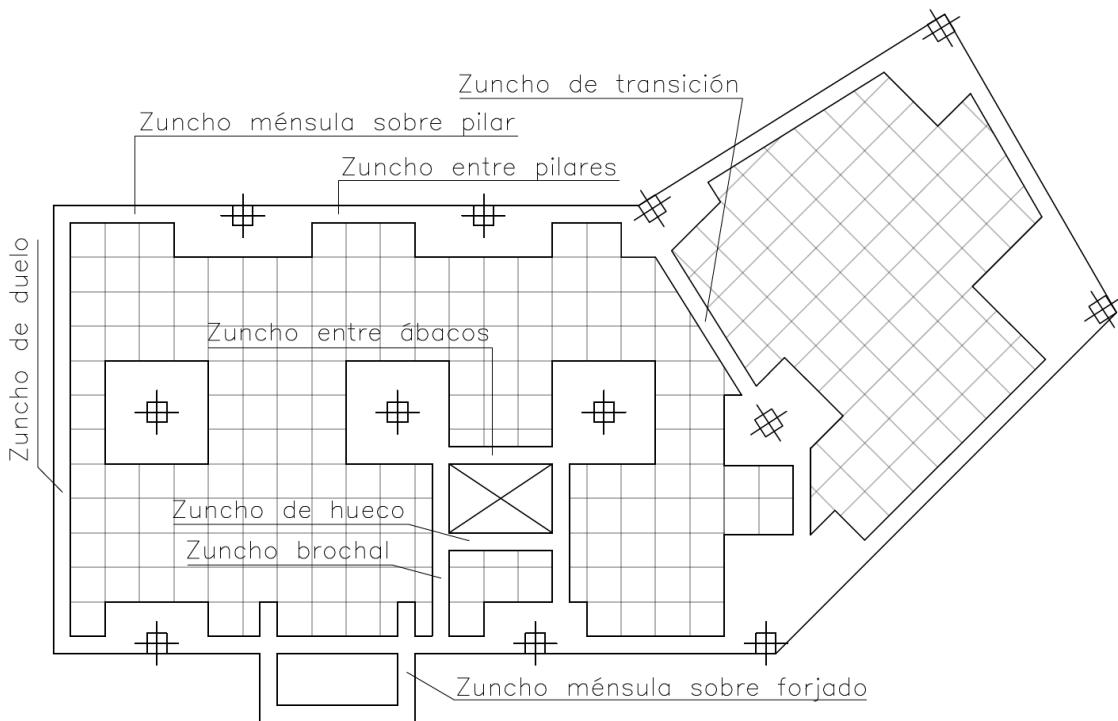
Croquis explicativo de los zunchos posibles en un forjado reticular
